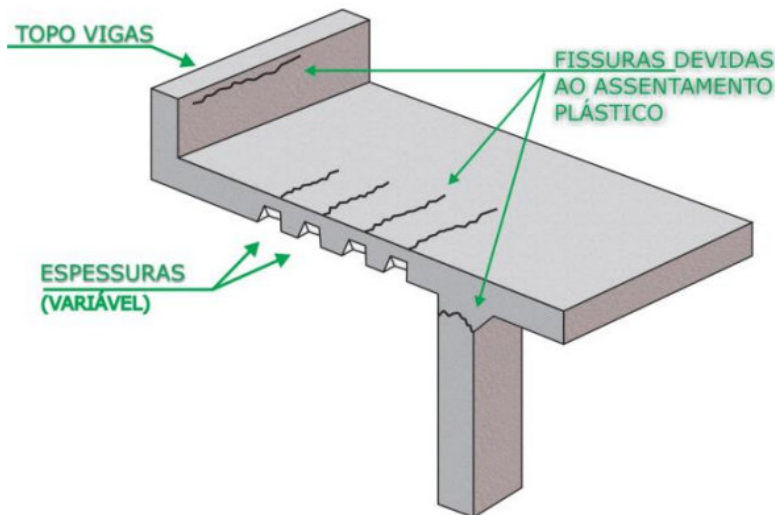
Fissuras devido ao assentamento plástico do betão (Leila Meneghetti, s.d.)
